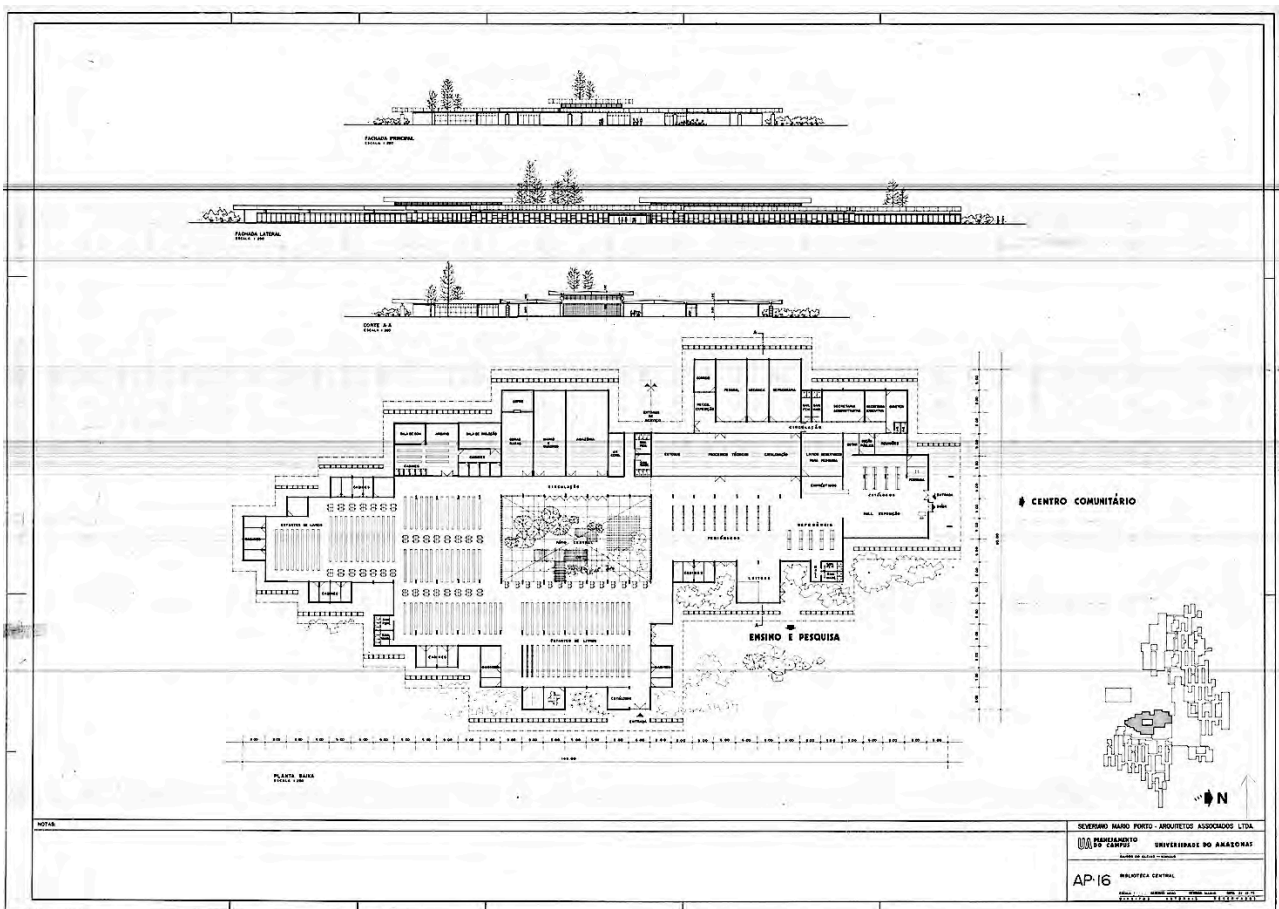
Setor norte do campus da UA. Biblioteca, 1973.
